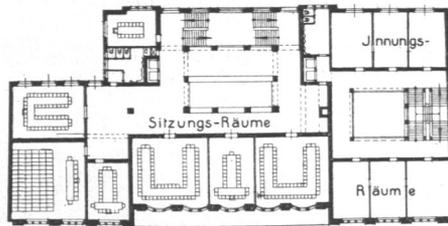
Gewerbehaus, 2. Obergeschoß, Grundriß.
